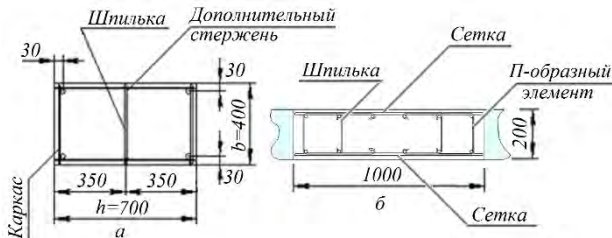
Схемы армирования колонны прямоугольного сечения (а) и отдельного участка стены прямоугольного сечения (б)
